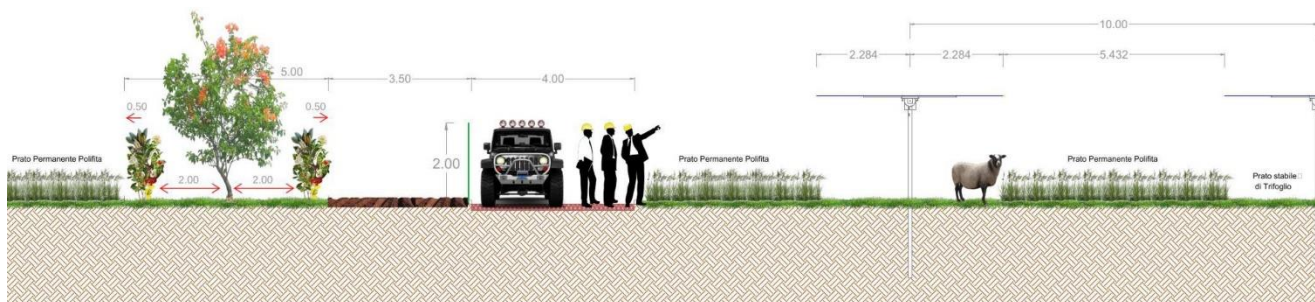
Sezione dell'impianto con l'indicazione della disposizione delle colture agrarie, della recinzione perimetrale e della fascia tagliafuoco esterna.
